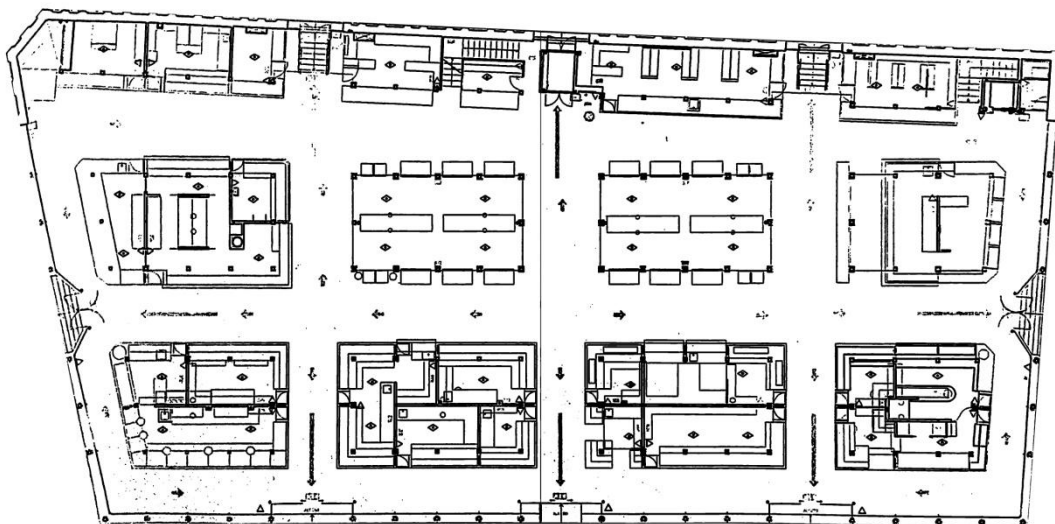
Planta Baja. Elaborada a partir de los planos de emergencia del Mercado. 2015.
